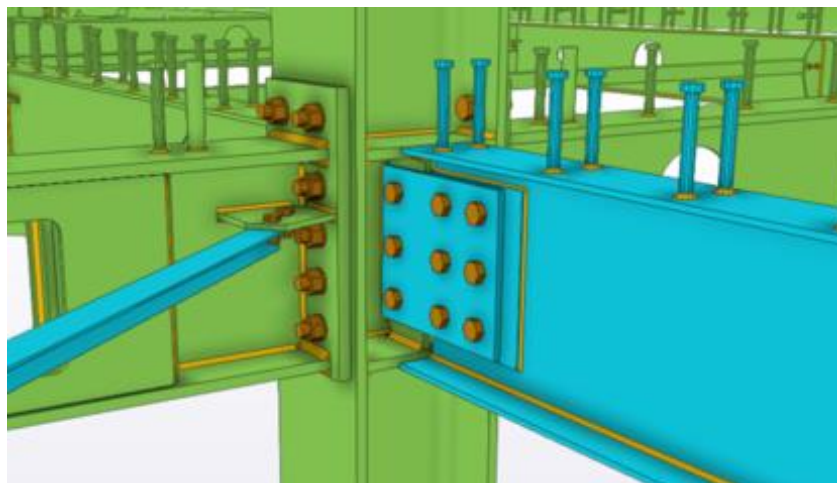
Ligação Coluna – Viga (Fonte: Software Tekla, 2023)
